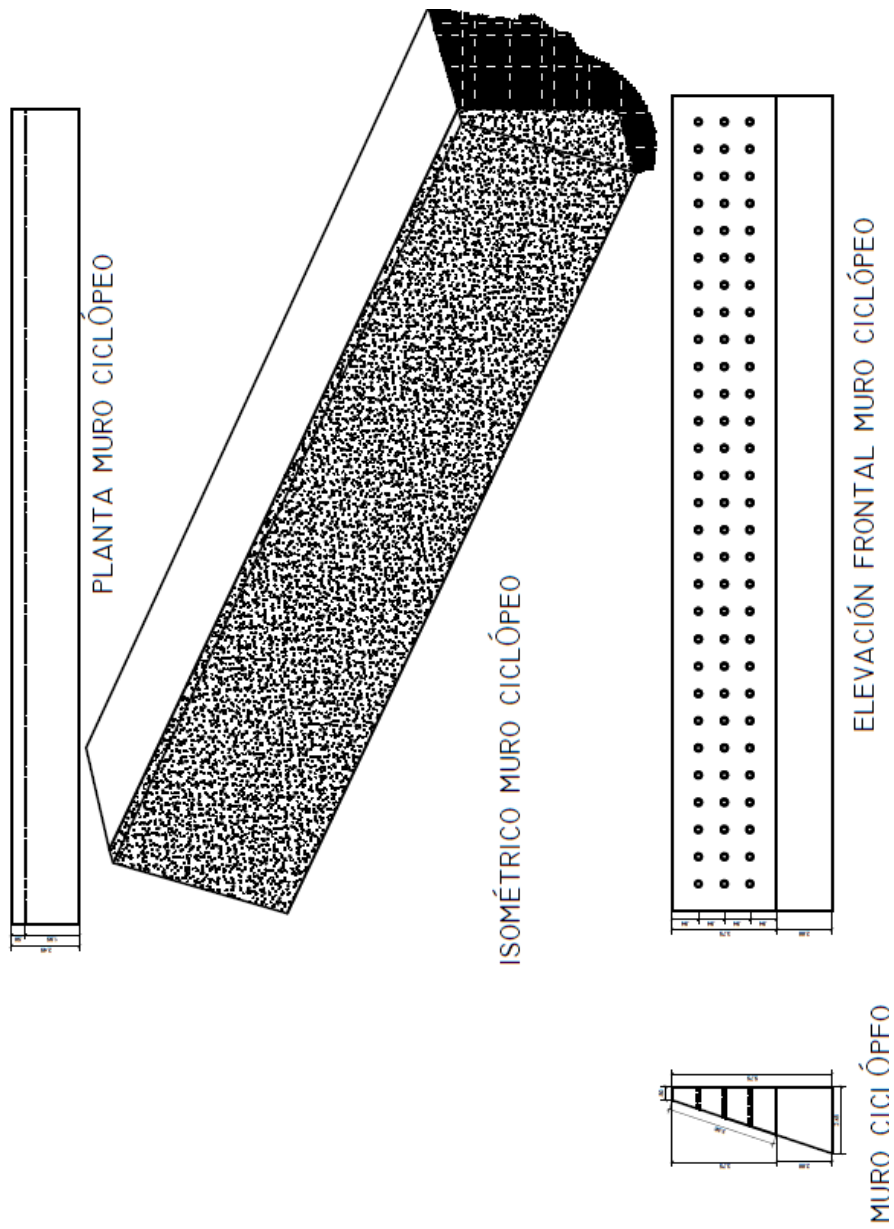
Detalle de muro de concreto ciclópeo propuesto para el pie de talud del cerro Lec
